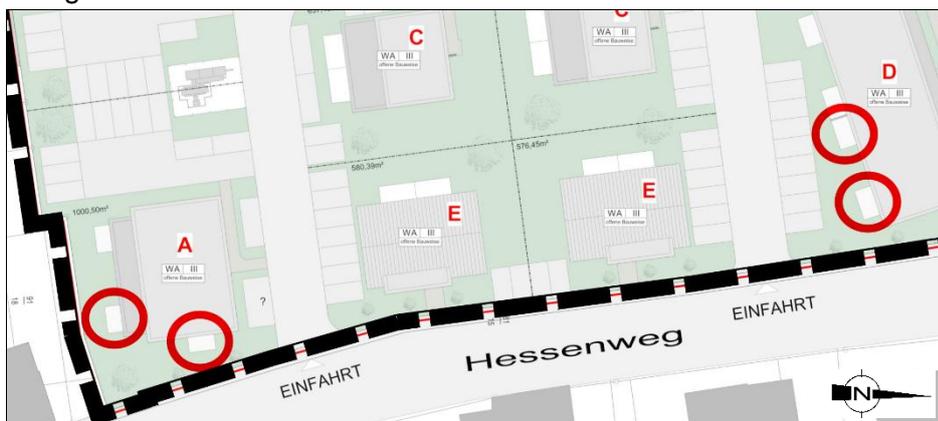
relevanten Fassaden mit Außenwohnbereichen
